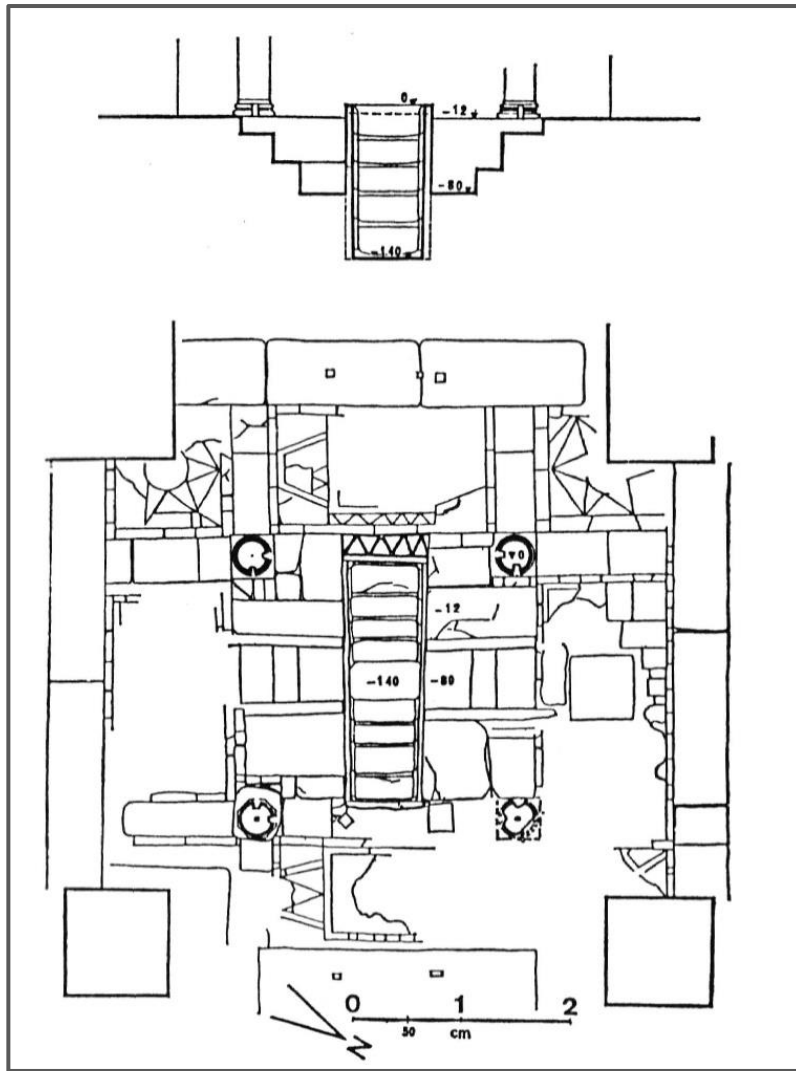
Bulla Regia. Planimetria e sezione del fonte battesimale
